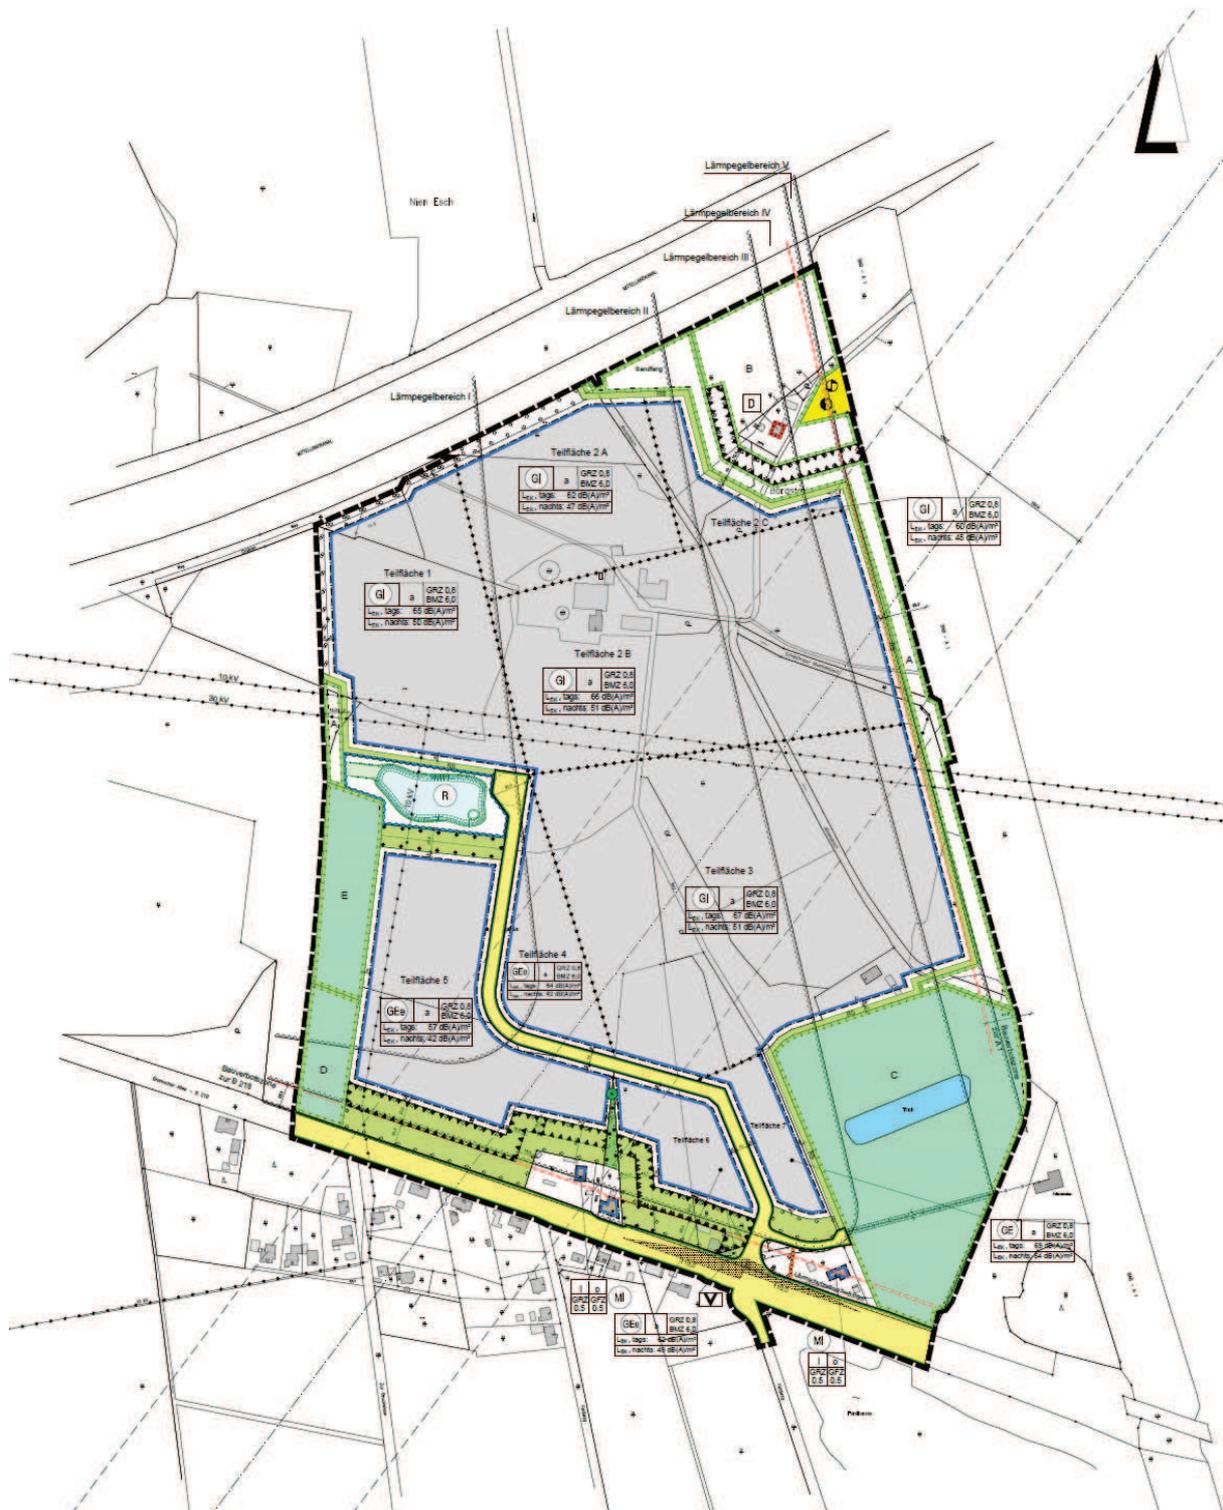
Bebauungsplan Nr. 155 „Industrie- und Gewerbegebiet A1 / Schleptrup“
